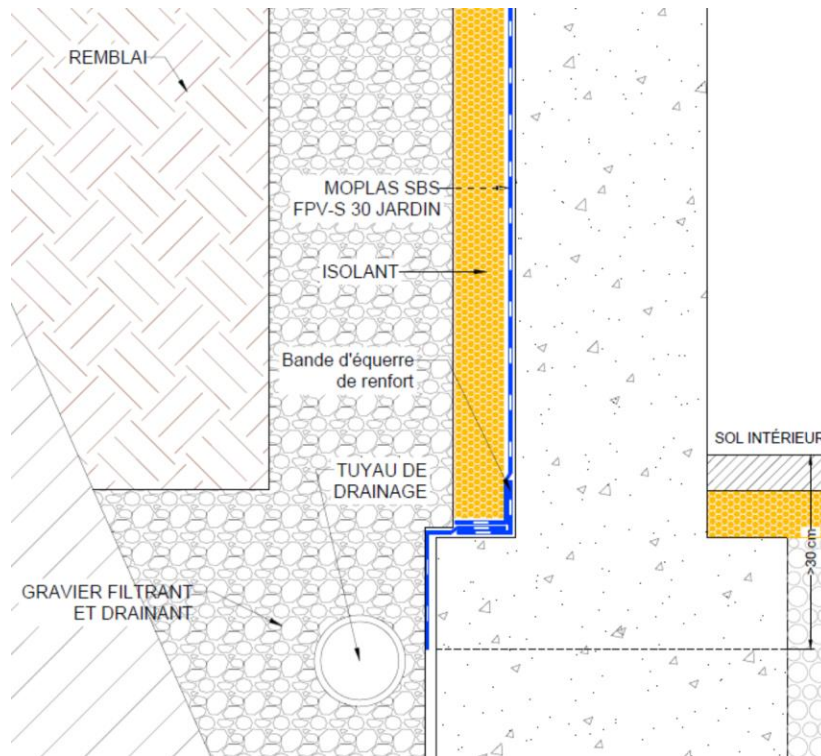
ter – Protection par panneaux XPS et détail en pied de fondation
